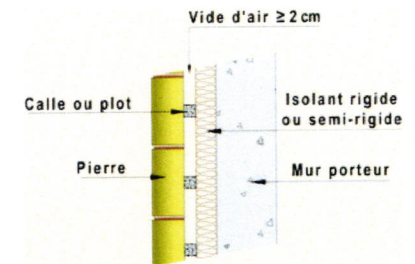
mur double. Source: pierres-info:revetement\_autoporteur.
